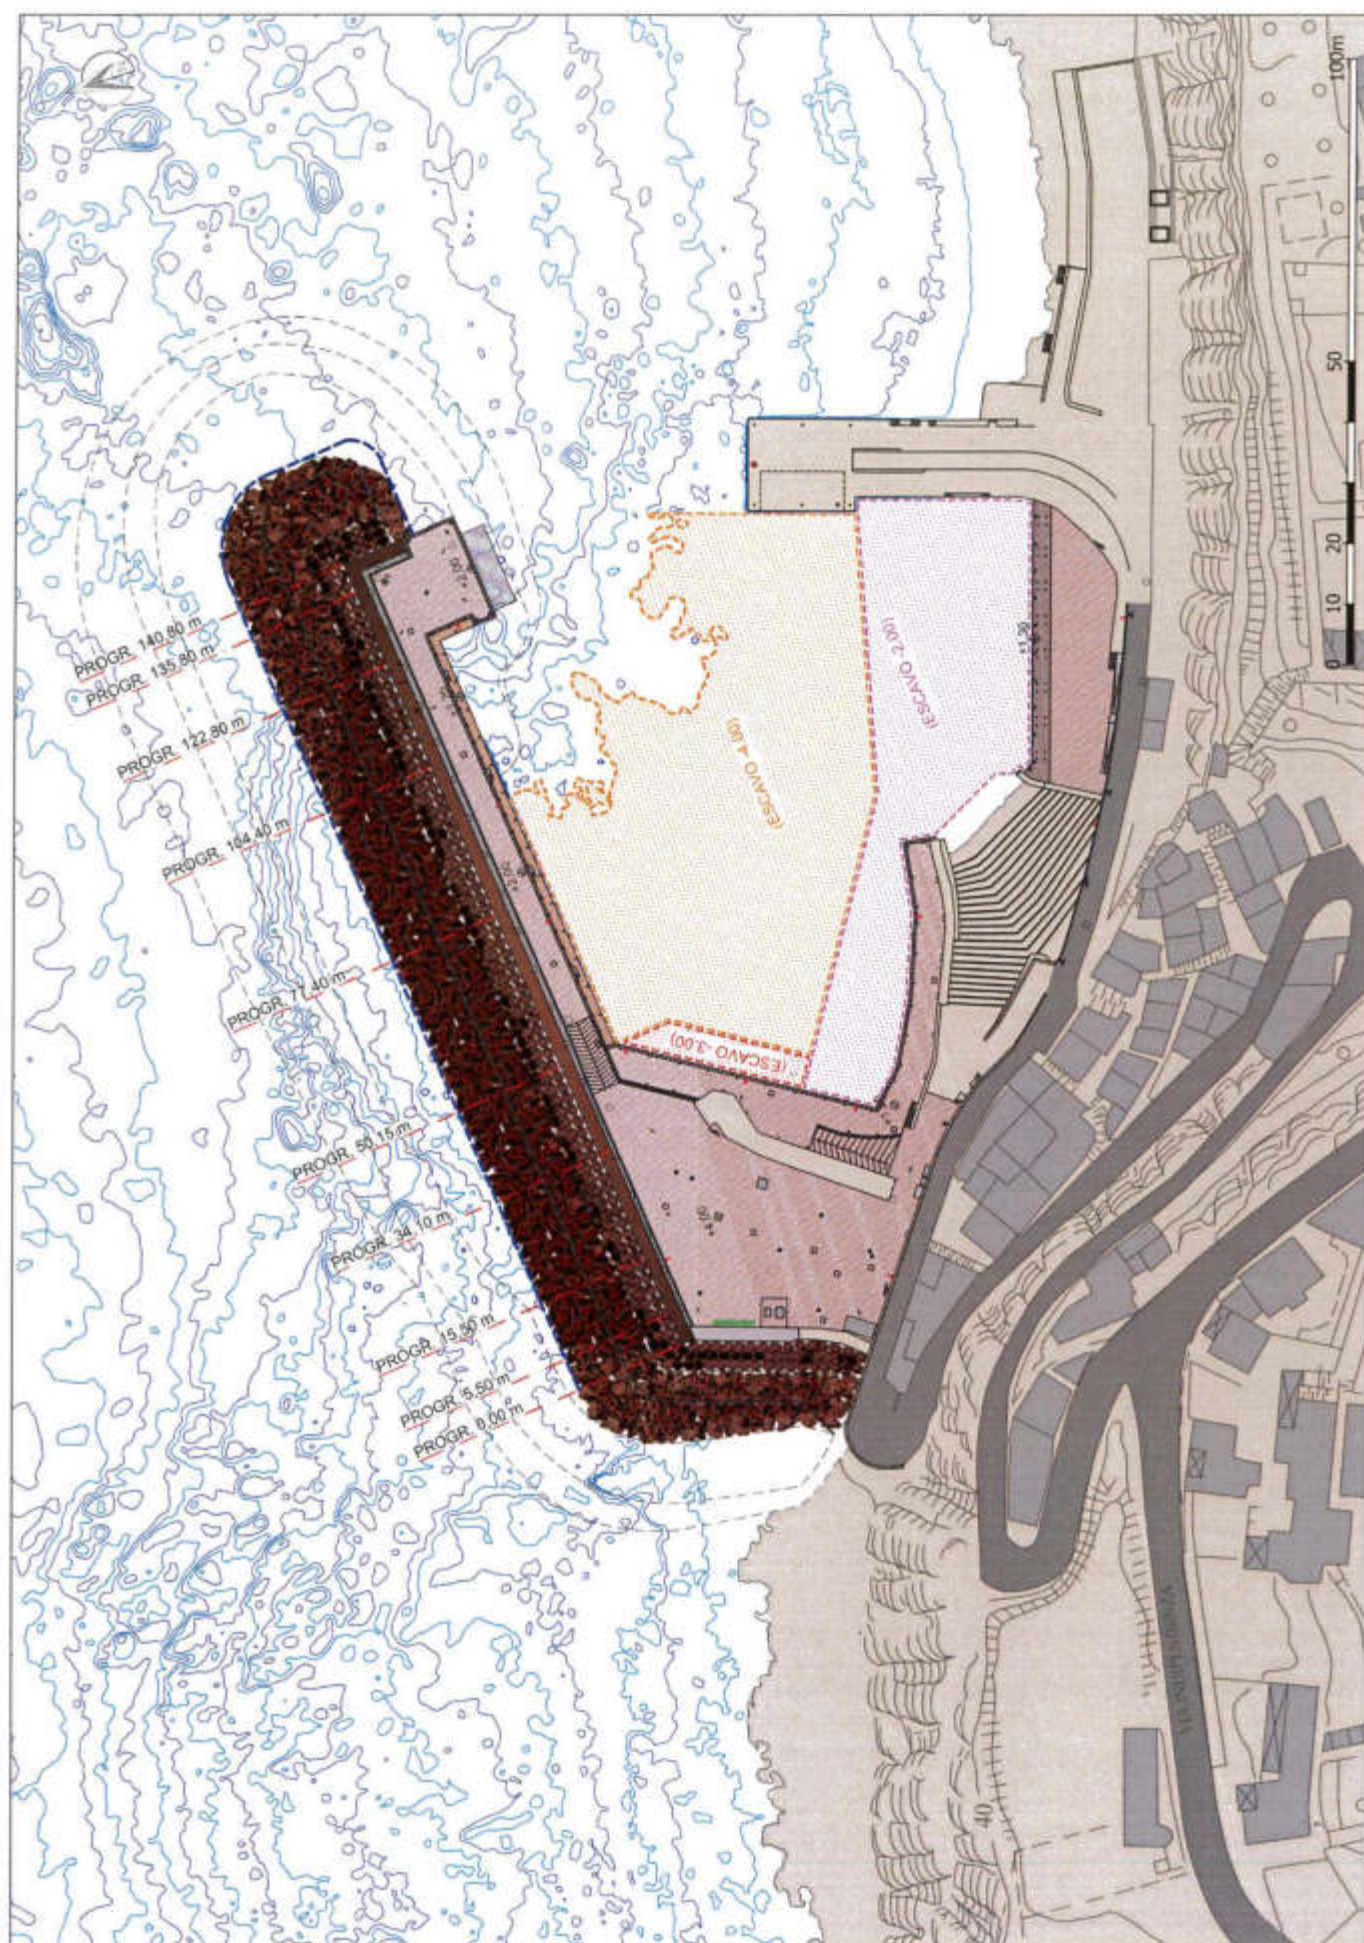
STRALCIO PLANIMETRICO SCHEMATICO DELLE OPERE IN PROGETTO
